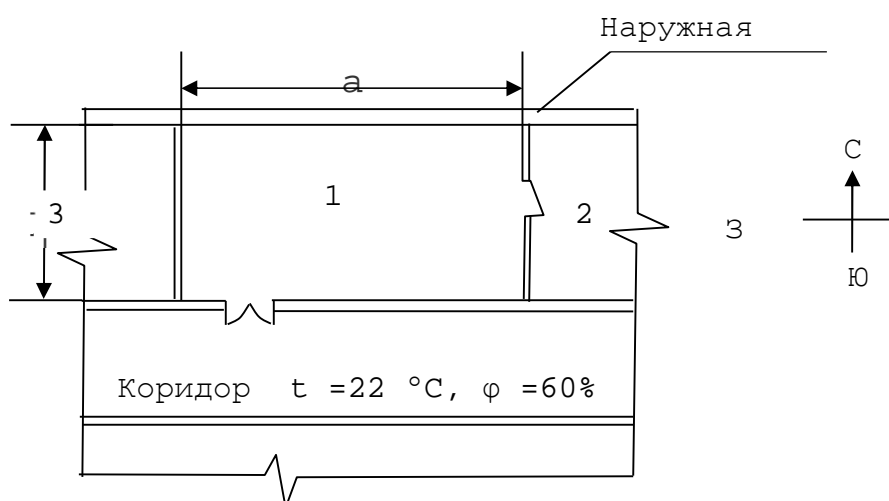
План этажа: 1 - обслуживаемое помещение,
